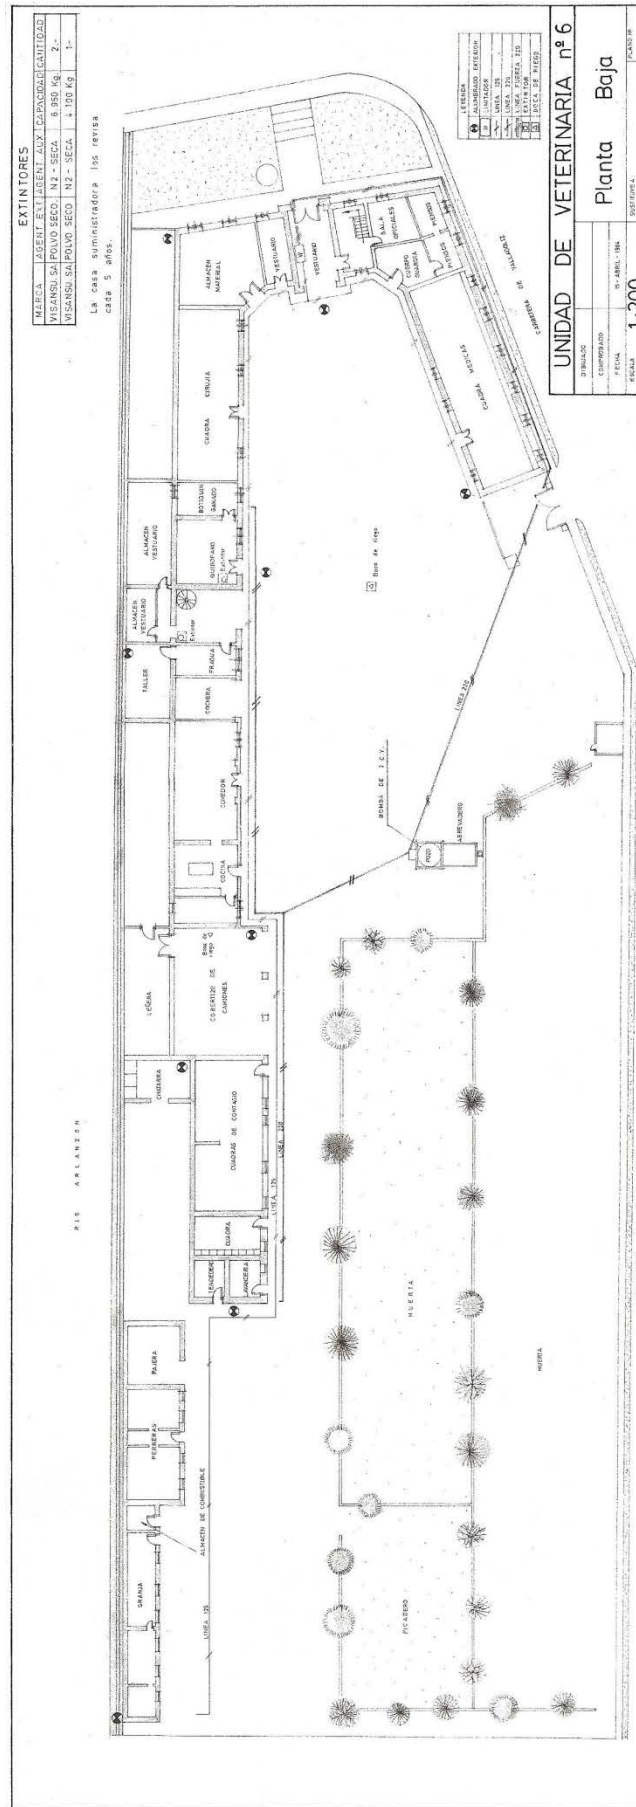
Plano de la planta baja del cuartel de Veterinaria (1984).
